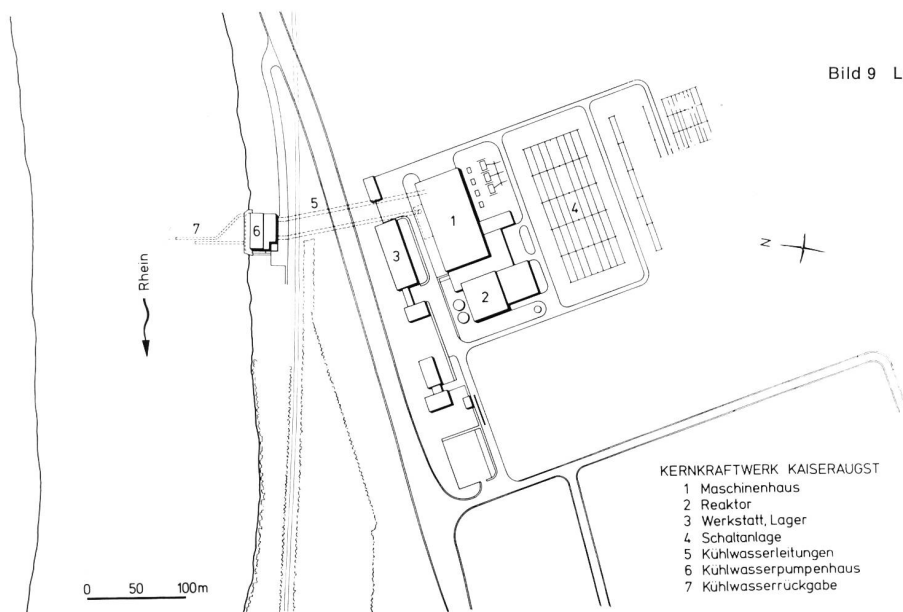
Lageplan des Kernkraftwerks Kaiseraugst
